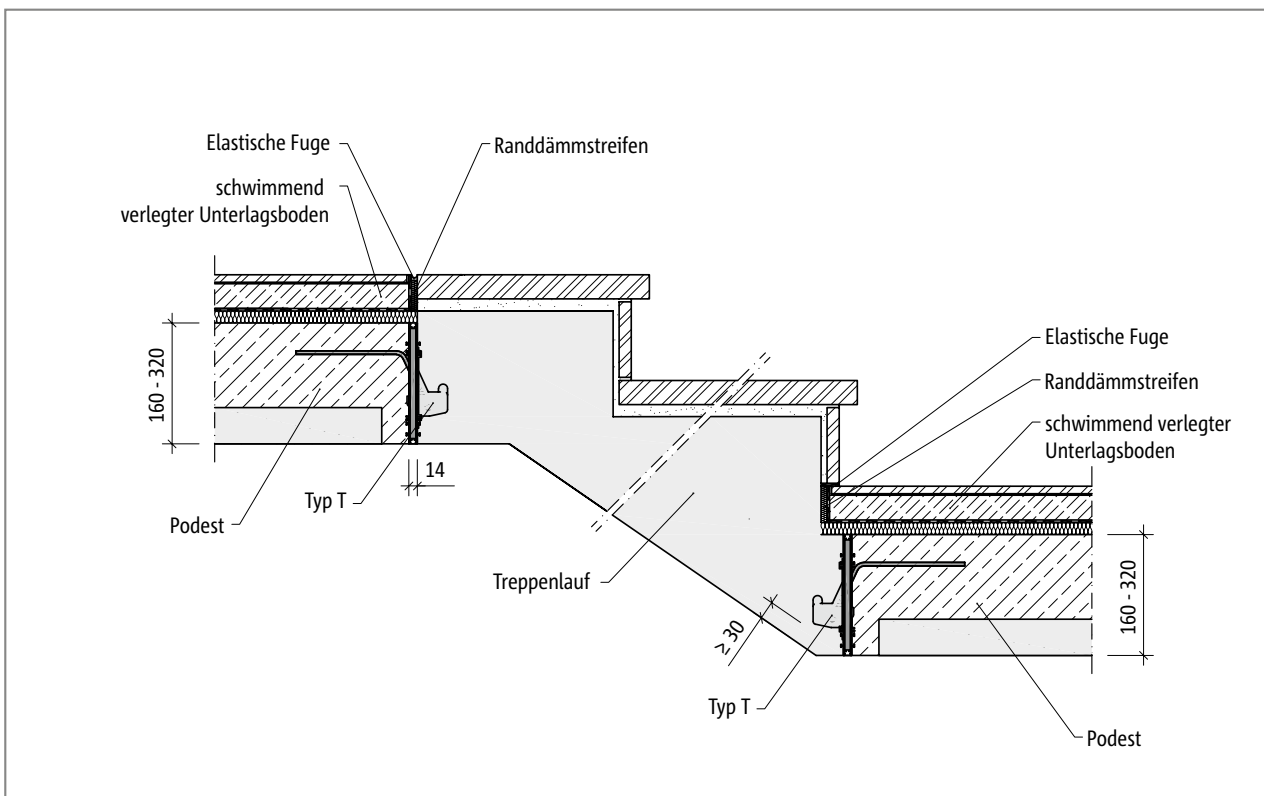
Schöck Tronsole® Typ T: Einbauschnitt Elementtreppe mit Halbfertigteilpodest
